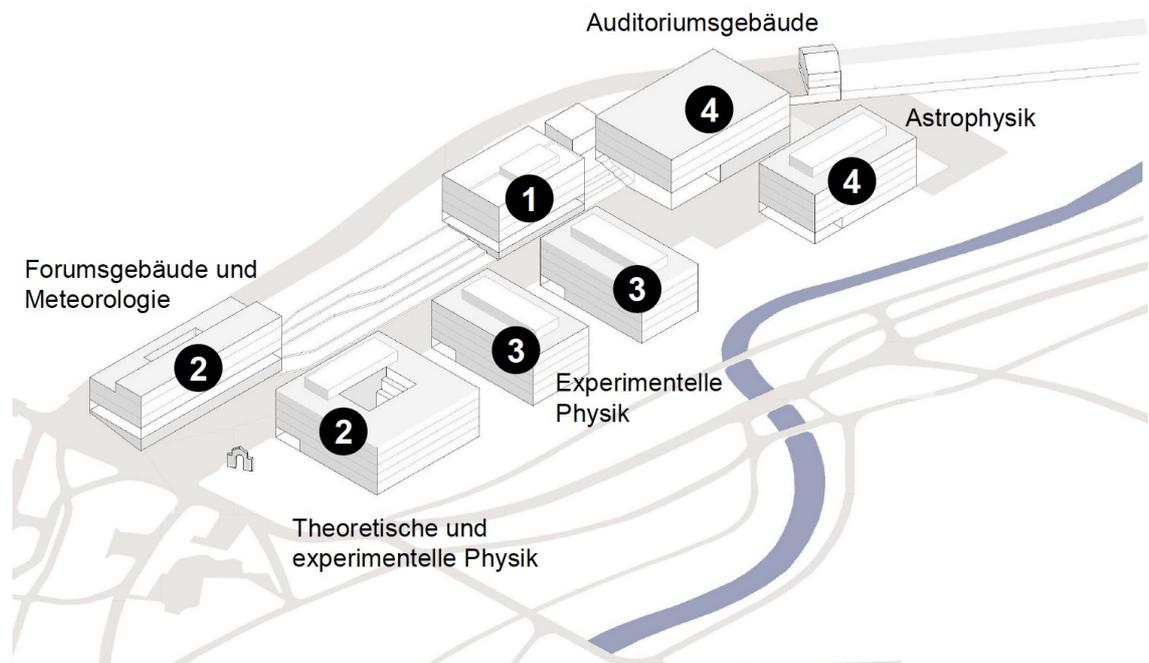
vorgesehene Bauabschnitte; Quelle: Staatliches Bauamt München 2
